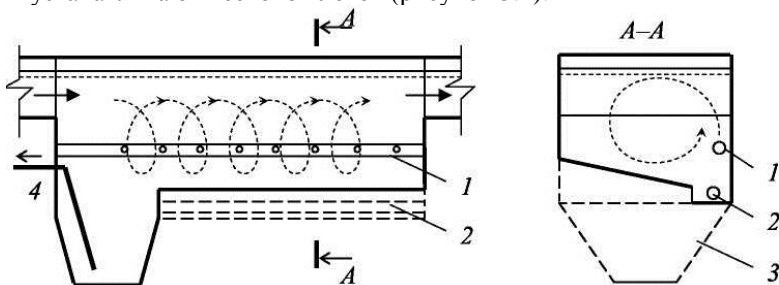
Схема аэрируемой песколовки с гидромеханической системой удаления осадка:
